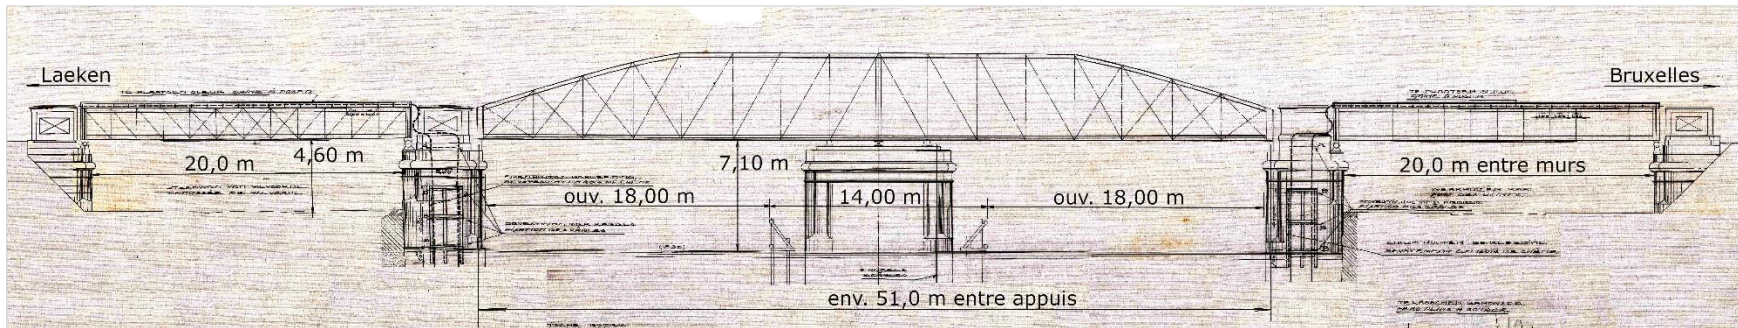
Élévation du deuxième pont ferroviaire de Laeken et des ouvrages d'approche (vue depuis l'amont ; d'après un plan d'installation de câbles en 1934)
